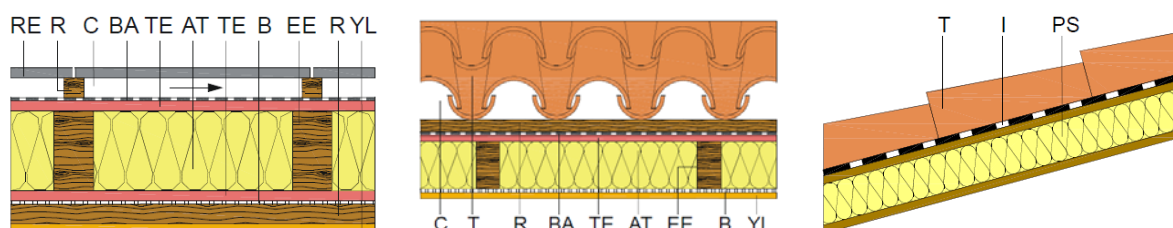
Ejemplos de fachada y cubiertas de madera del Catálogo de Elementos Constructivos [3][2].
